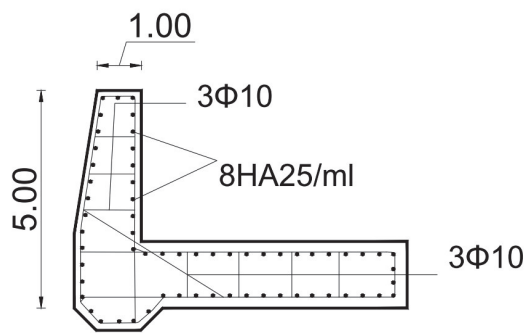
Schéma de ferrailage du mur de couronnement de la jetée principale
